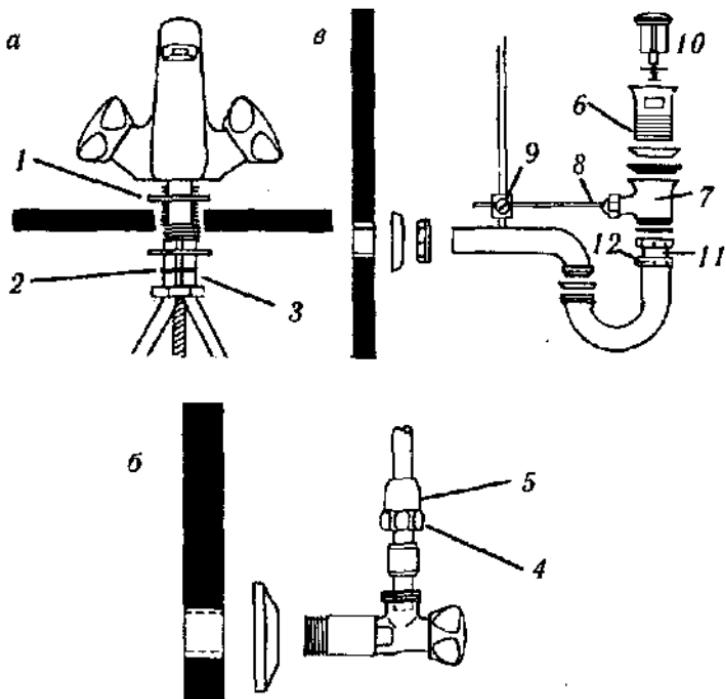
Монтаж умывальника: а — монтаж смесителя; б — подключение смесителя; в — монтаж выпуска и сифона; 1 — уплотнительная прокладка; 2 — металлическая шайба; 3 — контргайка; 4 — гайка; 5 — за jakiный конус; 6 — прокладка; 7 — выпуск; 8 — штанга клапана; 9 — муфта; 10 — пробка; 11 — труба; 12 — гайка.
